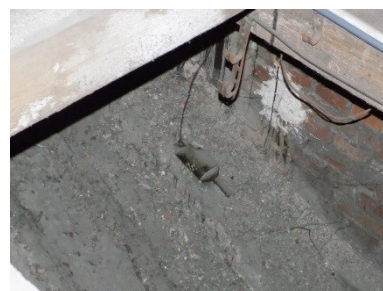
Sklepienie Rabbitz, pokryte elastyczną żywicą. Na pierwszym planie widoczne pozostałe stężenie
